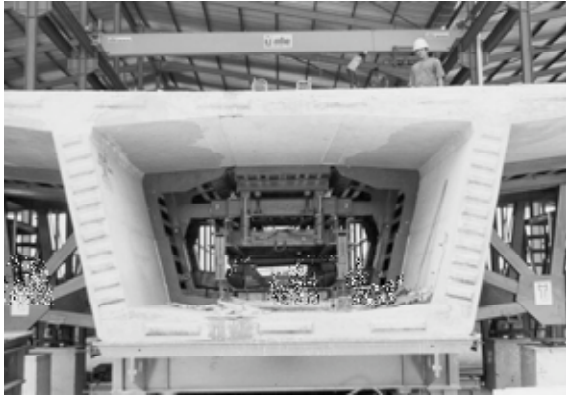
Dovela prefabricada de hormigón con llaves de cortante.
